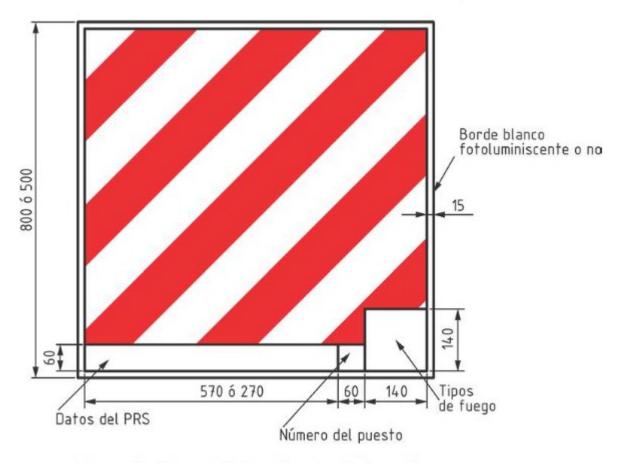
Chapas balizas horizontales o de piso Dimensiones en milímetros
